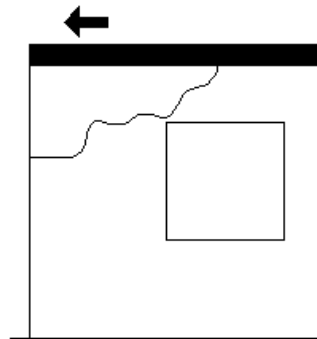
Fissura de cisalhamento devido à expansão térmica da laje.
